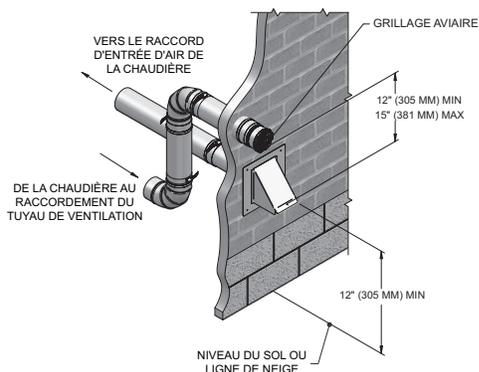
B Terminaison latérale en PVC/CPVC alternative d'air et de ventilation, avec raccords fournis sur place
